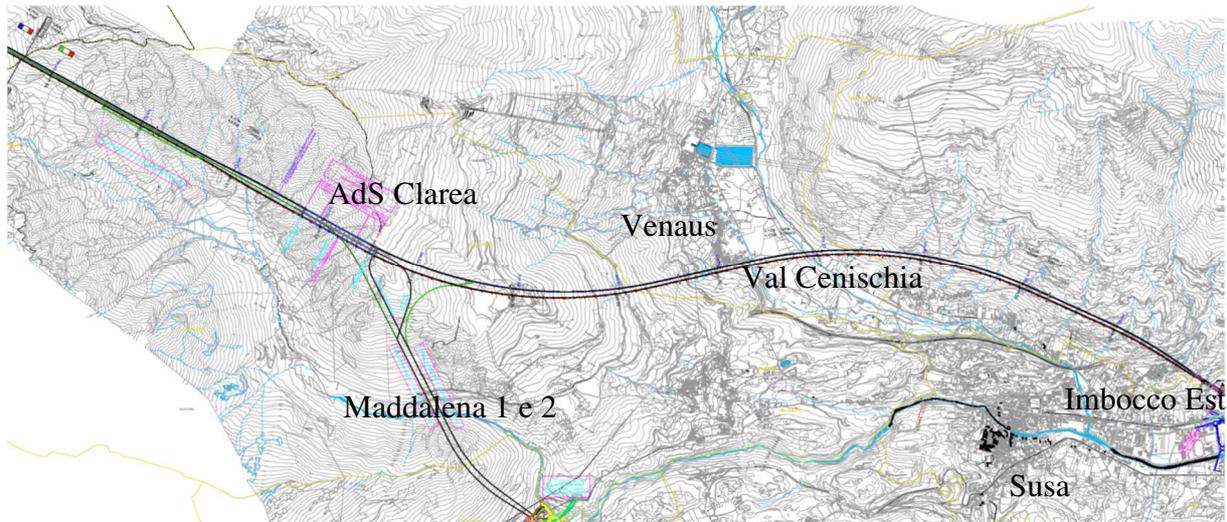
Planimetria del Tunnel di base nella tratta lato Italia
